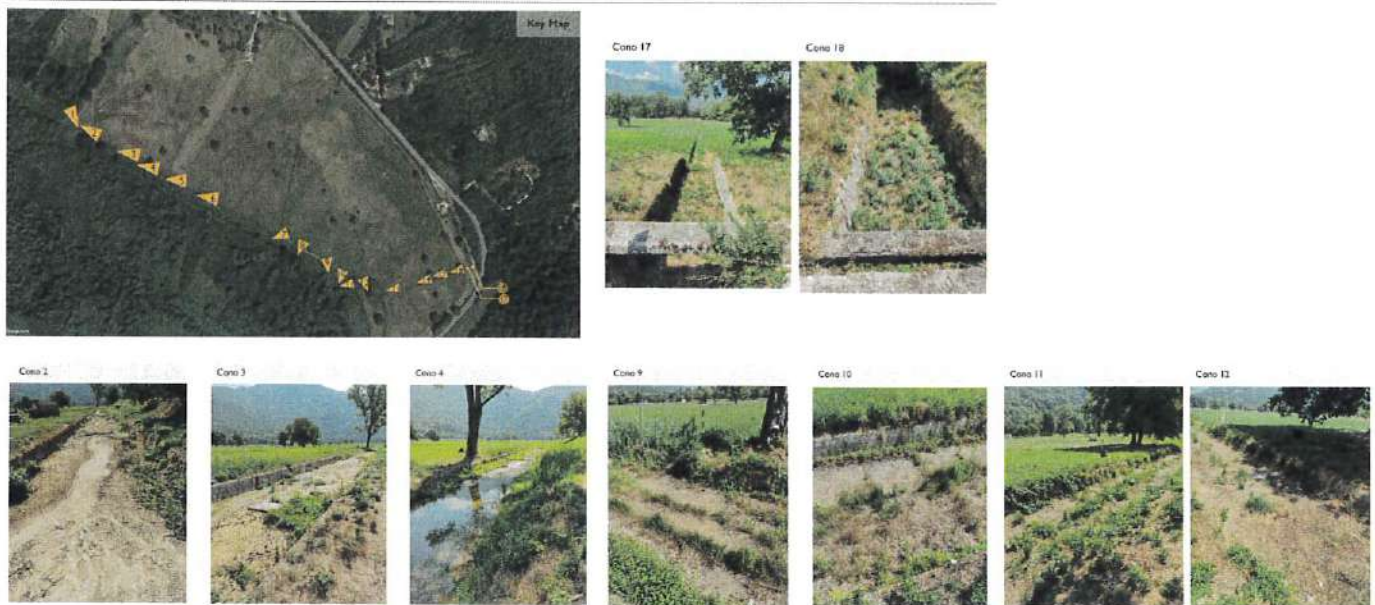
Stato di fatto del "fosso il Fiumetto" lungo tutta l'estensione dell'intervento TC1 (A250PDS\_R026\_0 - All.1 – documentazione fotografica)
